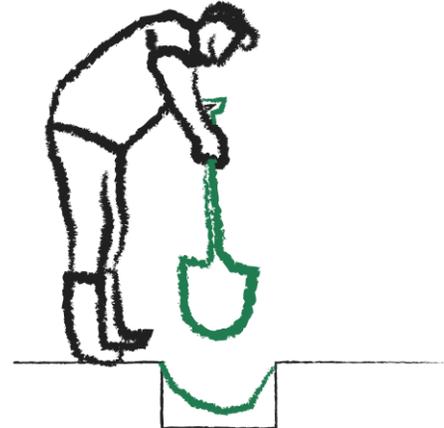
Trazo para zanja de captación pluvial. Fuente: elaboración propia.
